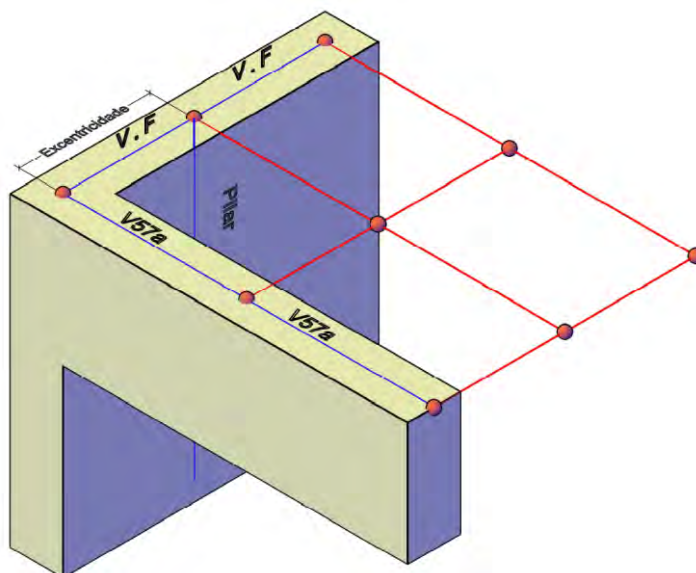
Isométrico da ligação excêntrica Viga-Pilar usando o artifício da viga fictícia.
